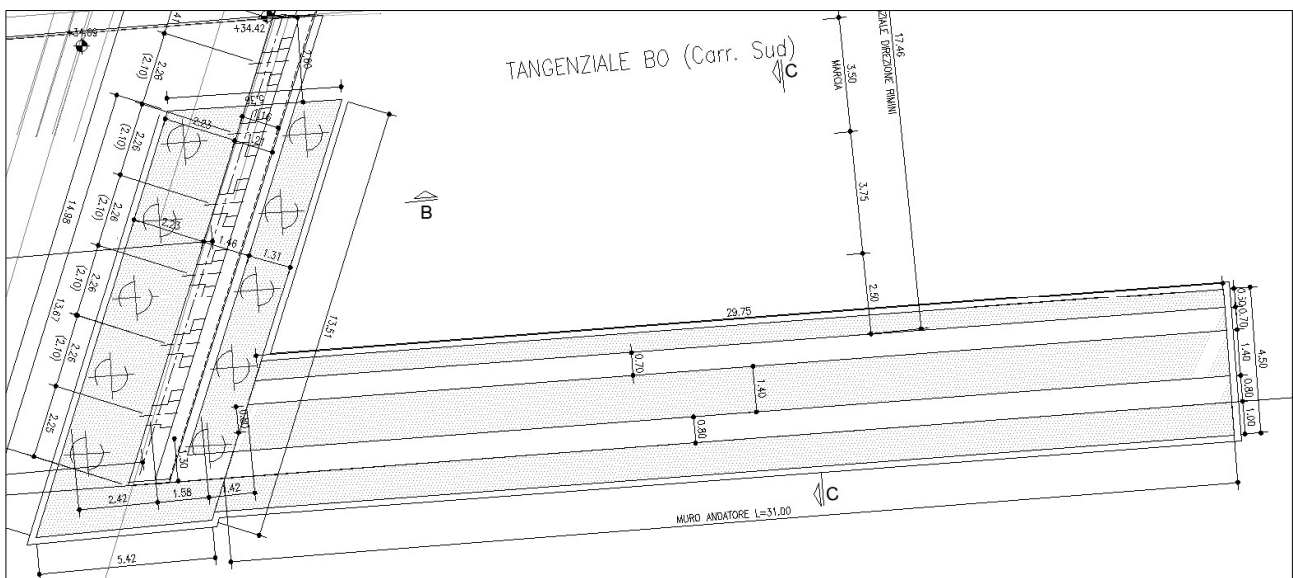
Posizione planimetrica del muro andatore lato Rimini – Allargamento Sud
